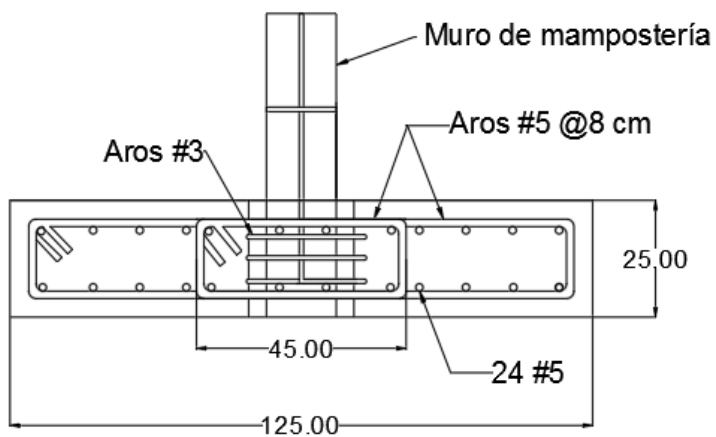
Sección transversal de la cimentación del muro RA.1.5.
